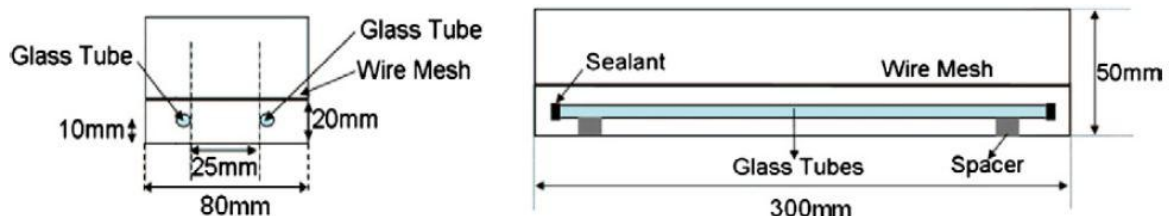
12 Schema di set-up di travetti con tubi e pipette [63]
